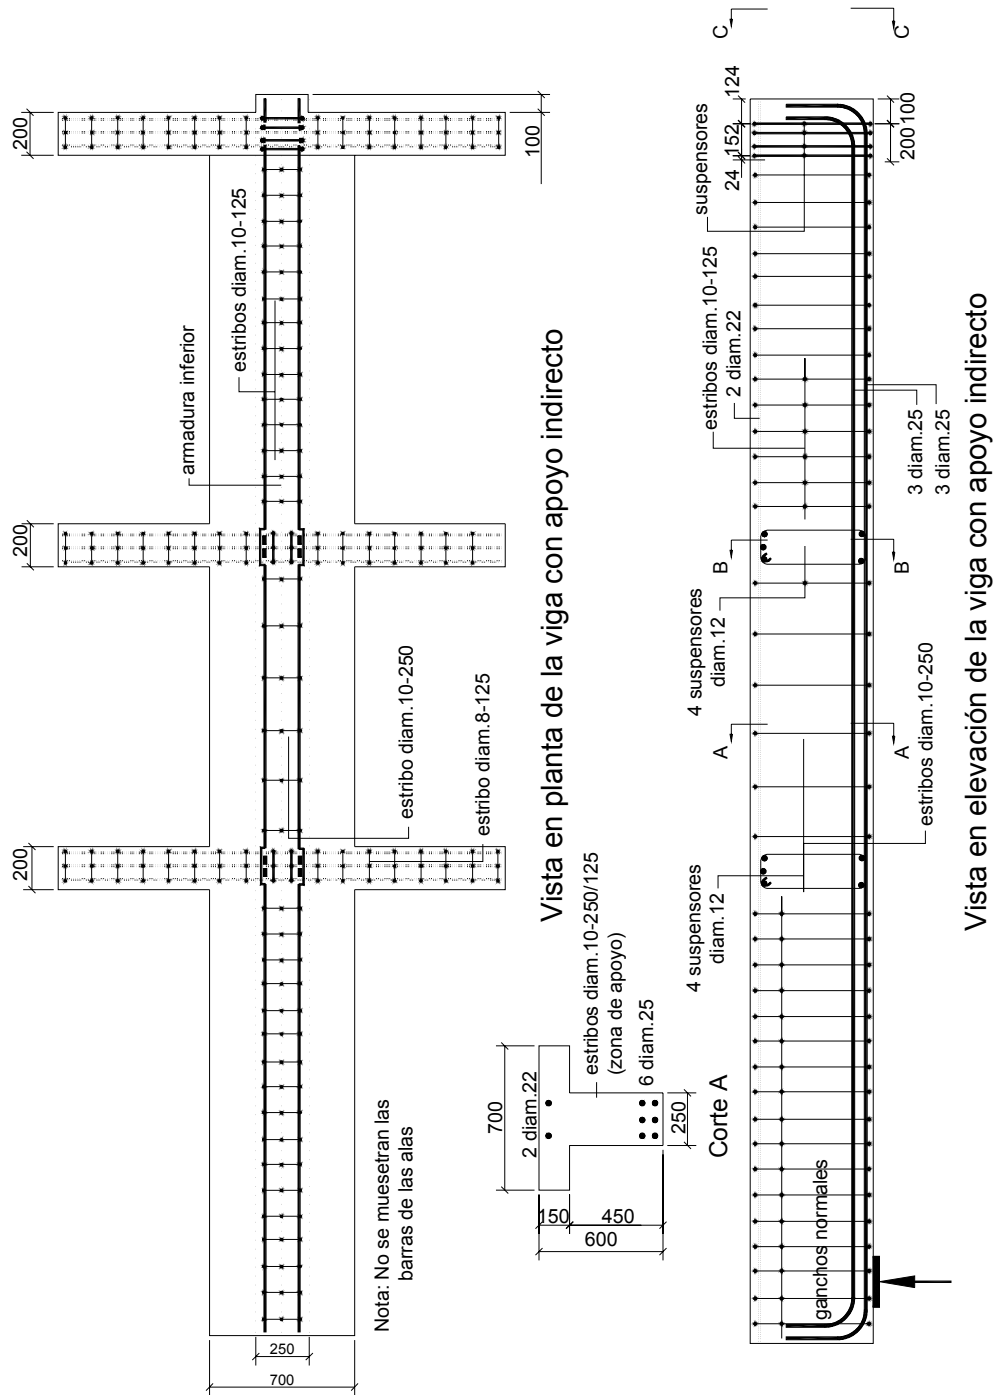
Vista y corte de una de las vigas con apoyo indirecto
